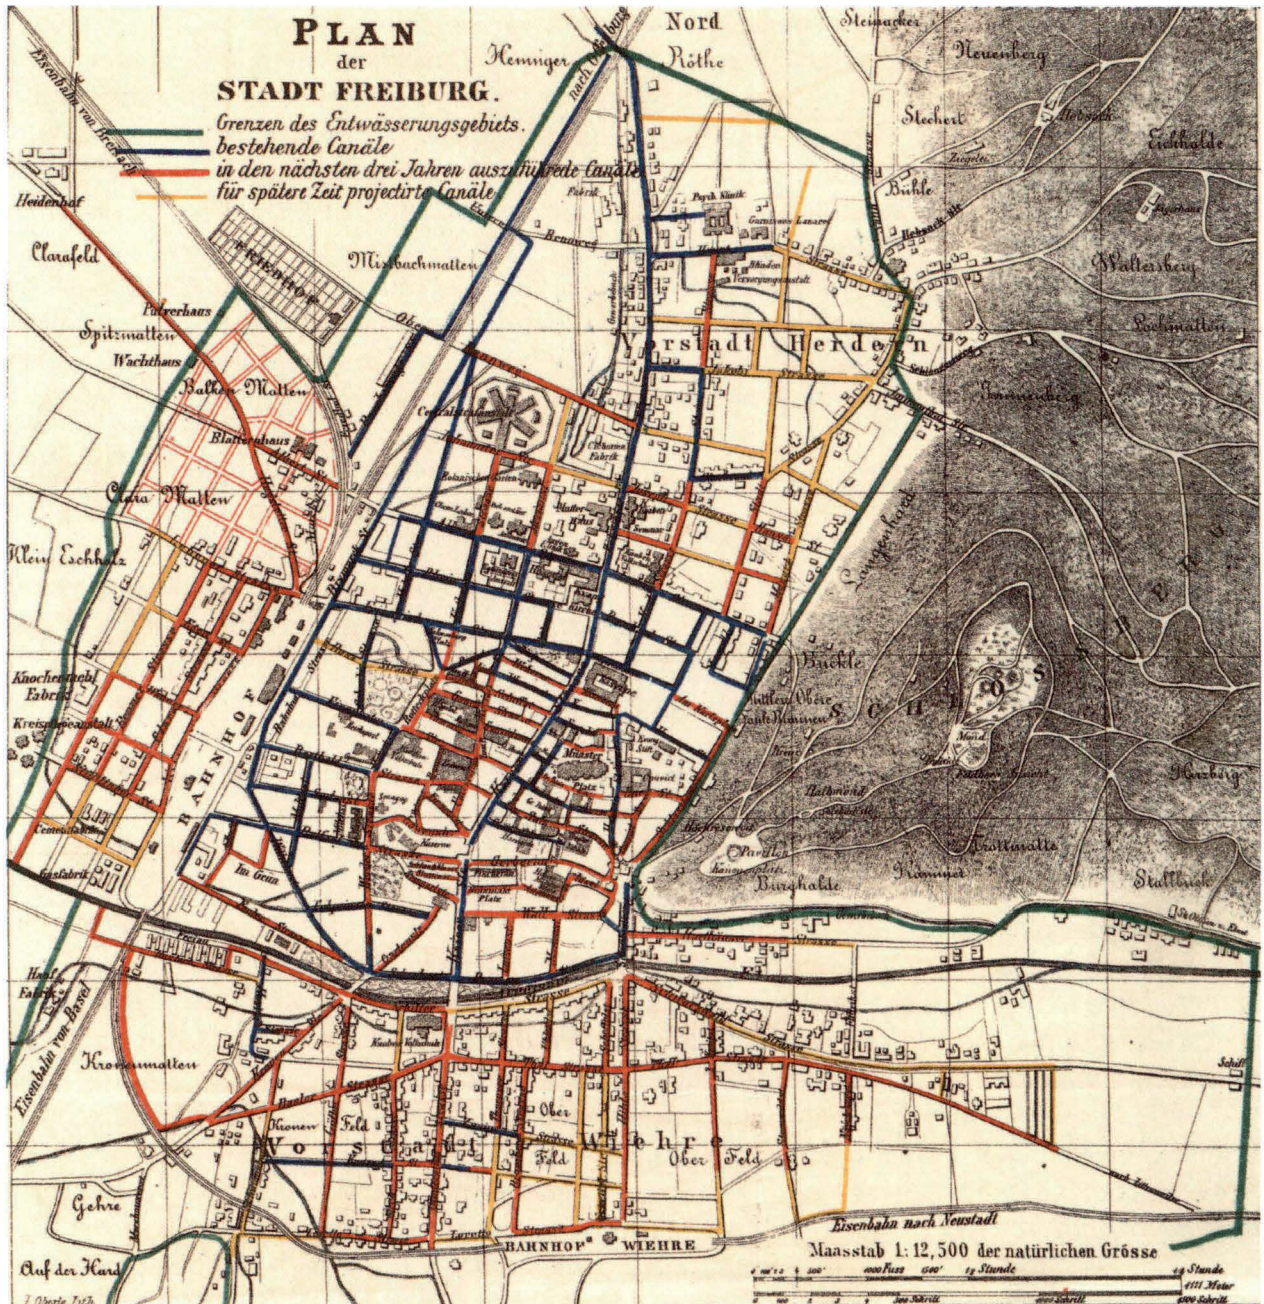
Plan des Standes der Kanalisierung im Jahr 1888 (StadtAF, C3/428/6).
